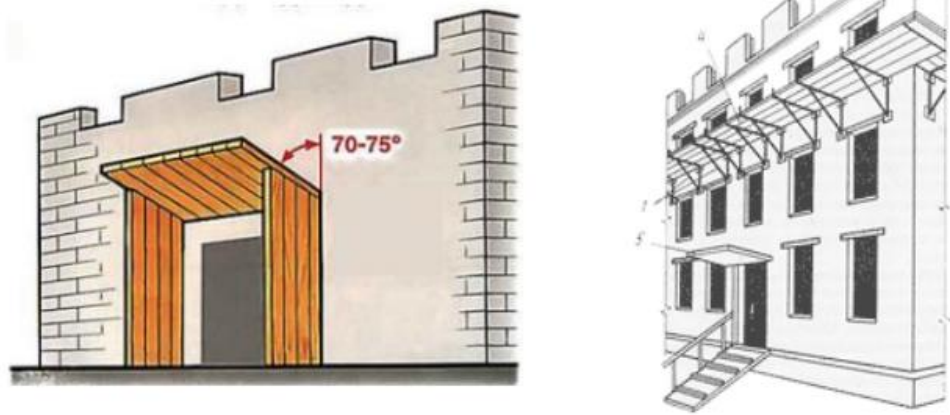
Захисний козирок над входом до будівлі (споруди)
